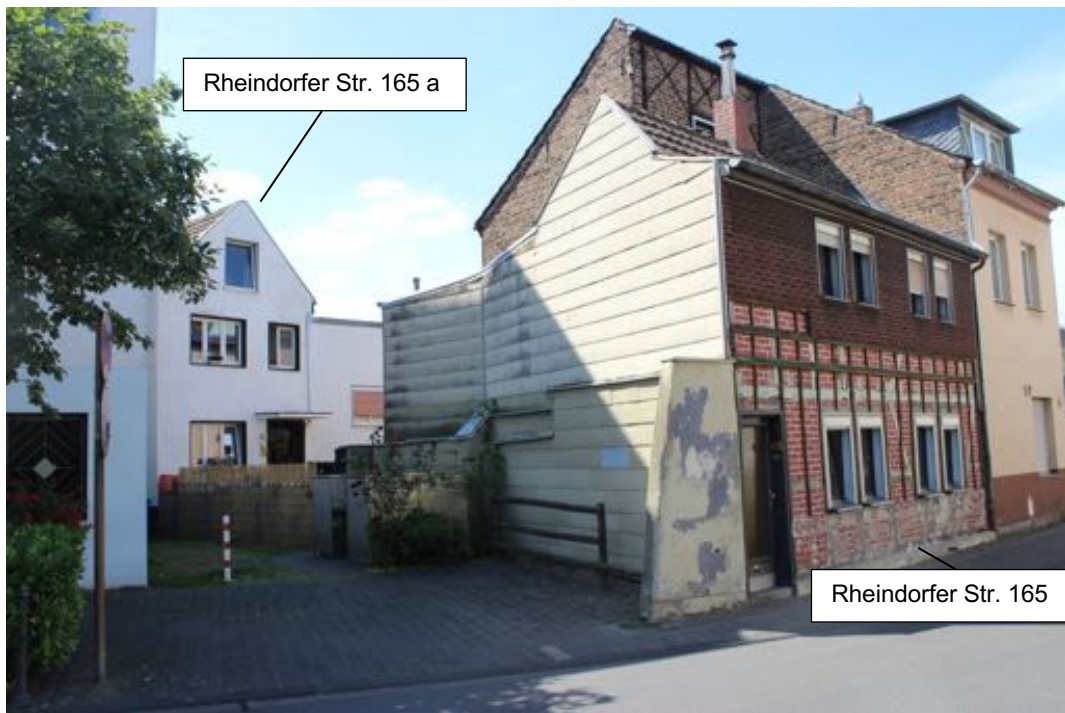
Straßenansicht Rheindorfer Str. 165 a und 165
